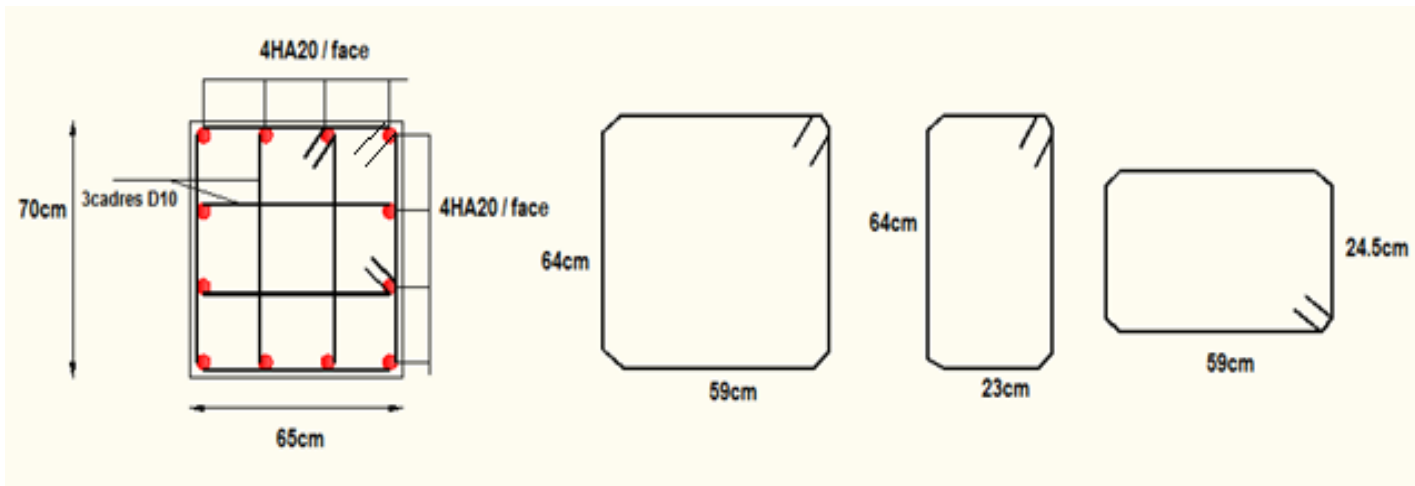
Schéma de ferrailage des poteaux d'étages 3,4,5
